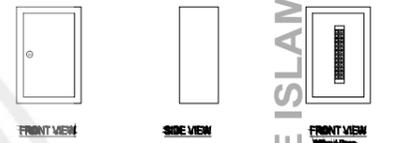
DETAIL PEMASANGAN DETEKTOR FIRE ALARM
